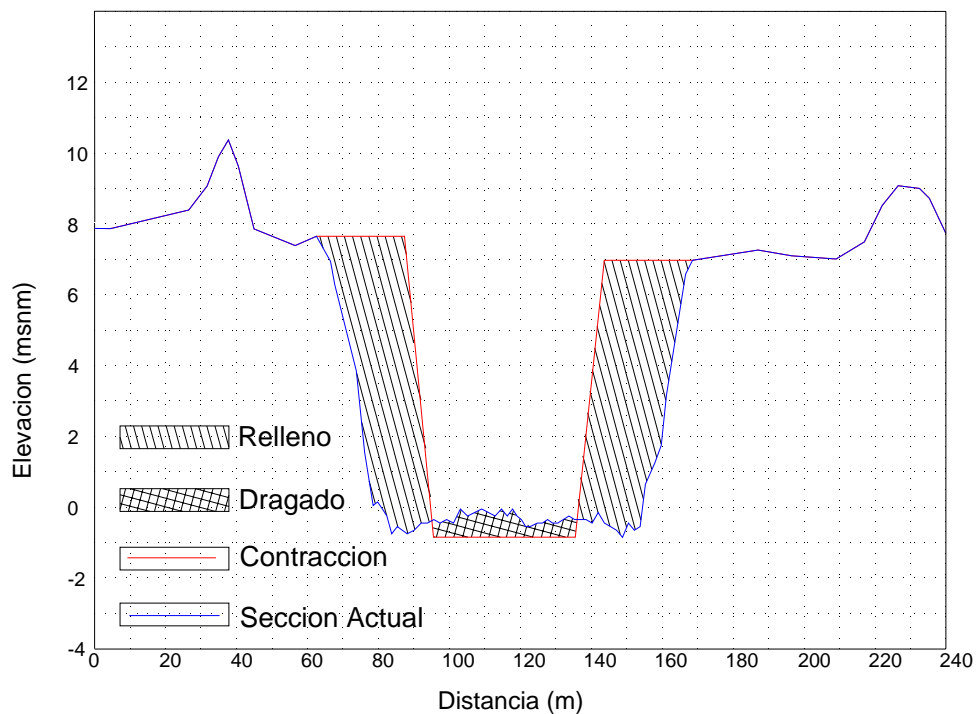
Sección transversal km 6 - Contracción No. 1
